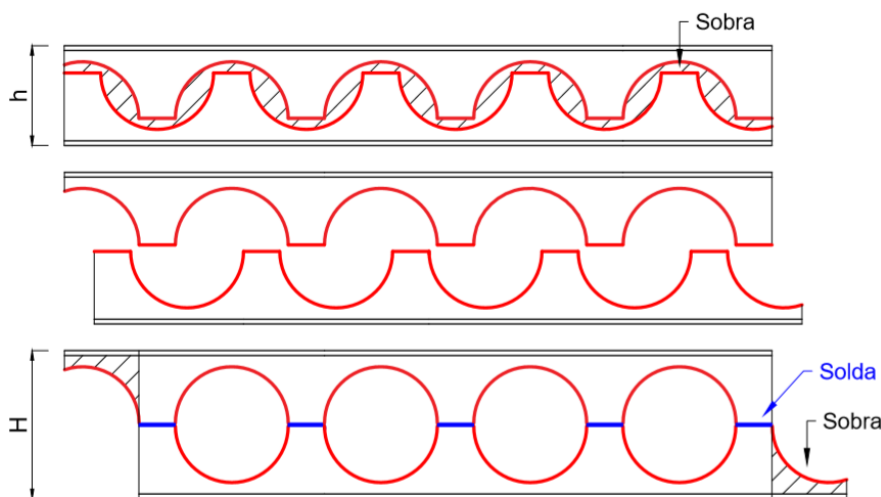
Execução das vigas alveolares com o incremento da altura.
